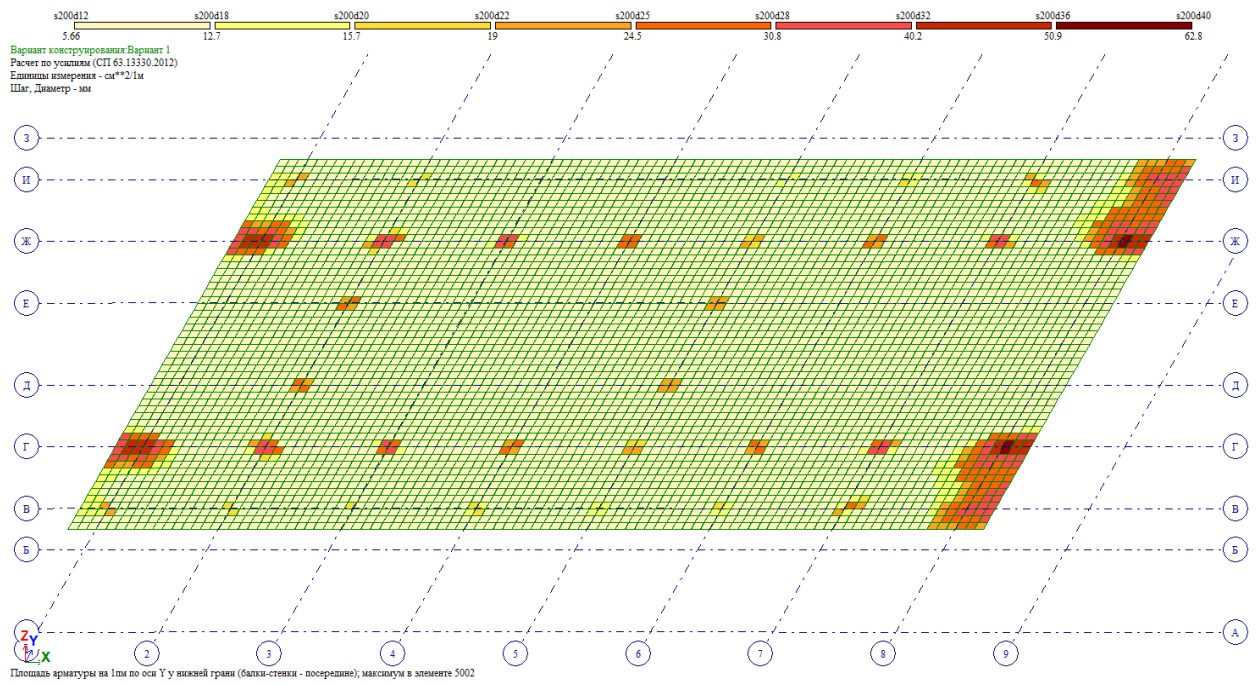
Площадь арматуры по оси У у нижней грани
